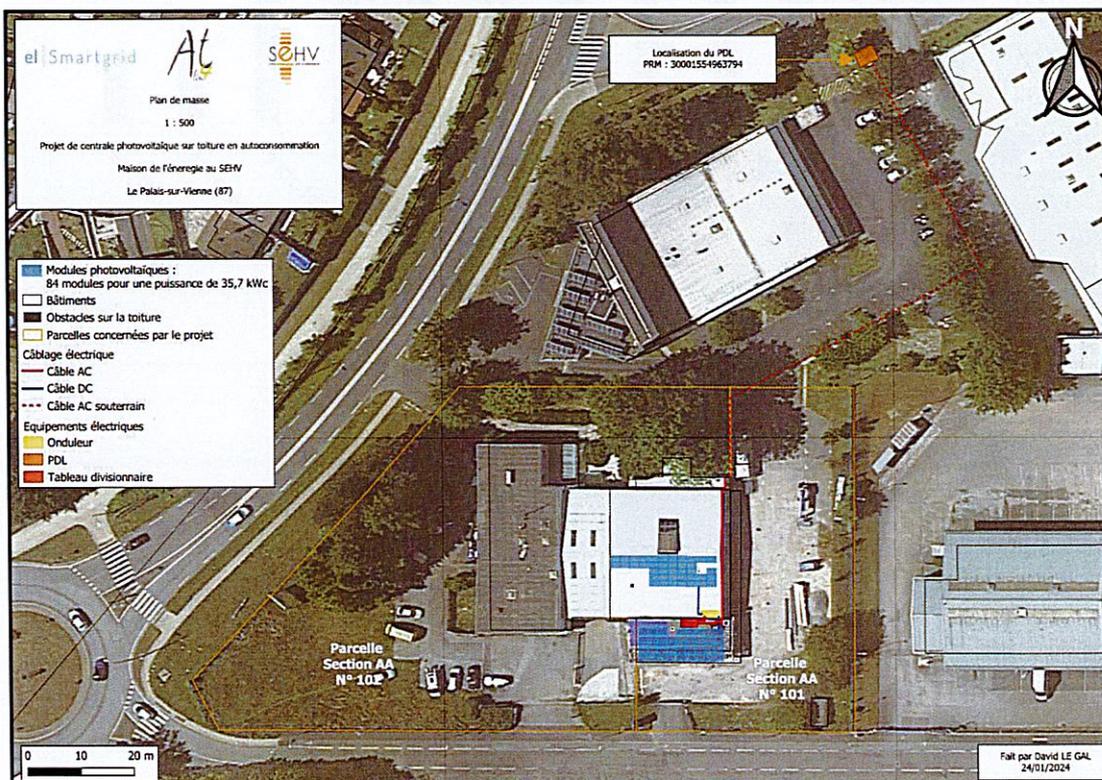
Plan de calepinage de la central photovoltaïque 35,7 kWc
